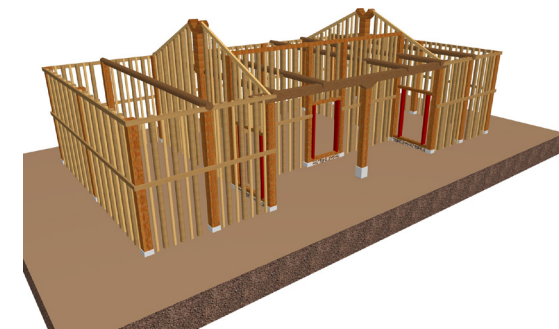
UMBRALES DE LAS PUERTAS.
